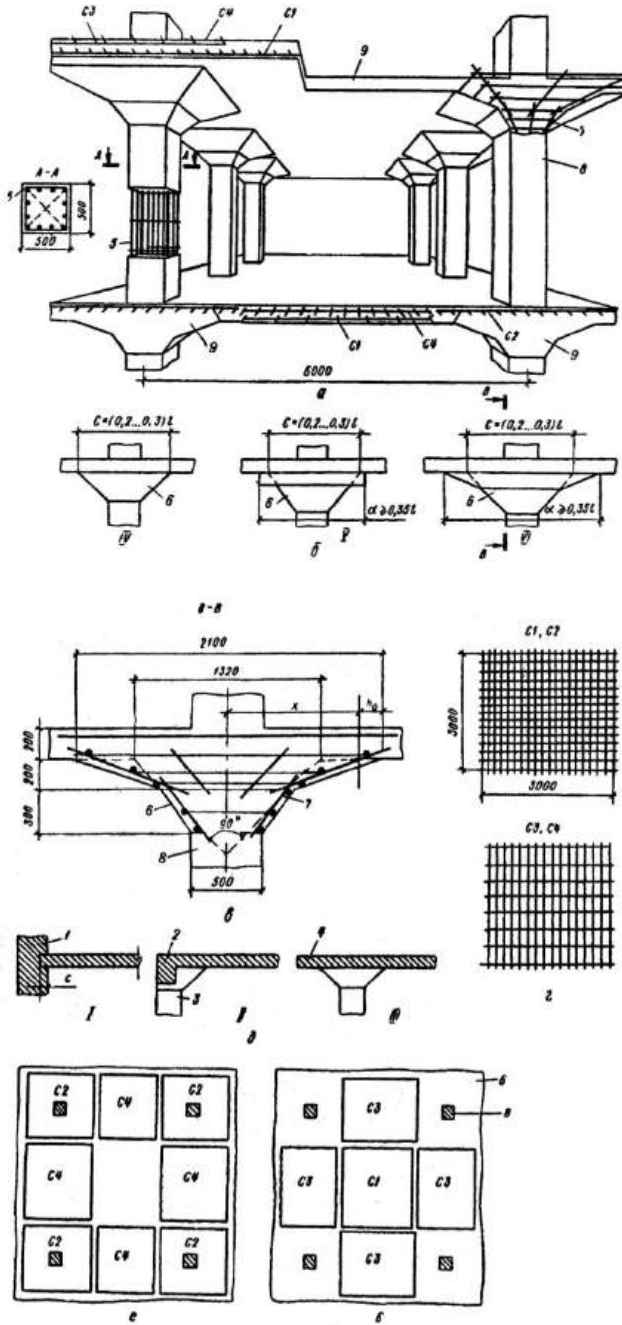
Монолітне безбалкове перекриття: *a* – загальний вигляд; *b* – види капітелі; *в* – армування капітелі; *г* – типи сіток; *д* – типи опирання плит; *e* та *є* – схема армування плит відповідно верхніми та нижніми сітками; *I* – опирання плити по контуру будівлі на несучі стіни; *II* – те саме, на контурні об'язувальні балки; *III* – консольне опирання на капітелі; *IV* – тип капітелі при навантаженнях менш як 10 кН/м^2 ; *V* та *VI* – те саме, при навантаженнях понад 10 кН/м^2 ; *1* – стіна; *2* – об'язка; *3* – крайня колона; *4* – консоль; *5* – арматурний каркас колони; *б* – капітель; *7* – каркас капітелі; *8* – колона; *9* – перерізи, в яких арматуру умовно не показано
